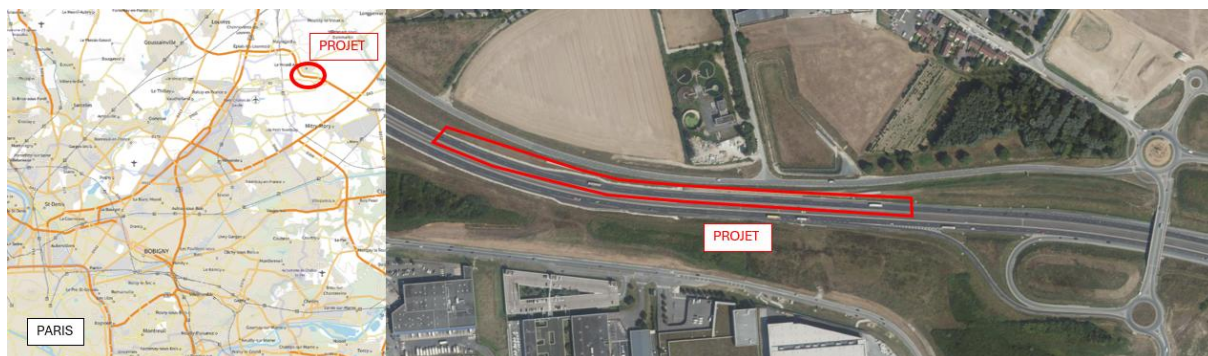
| Contexte : plan de situation des travaux [Source : SCE]
